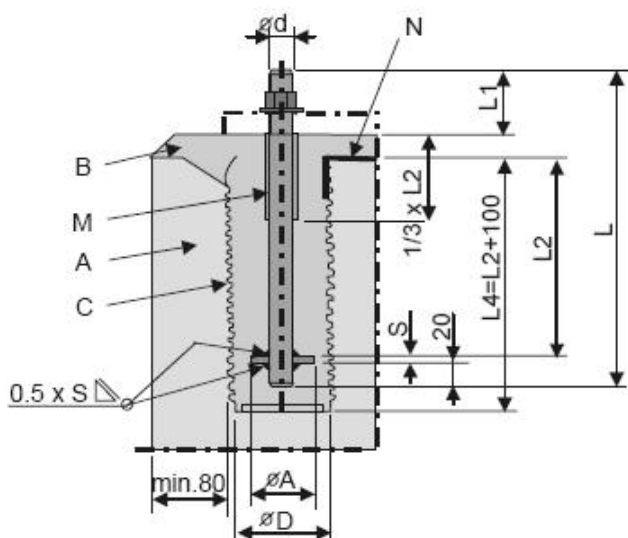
Короткие фундаментные болты с фланцем: размеры фундаментного болта стандарта SFS 4632, тип A. На рисунке обозначены: бетонный фундамент (A), вторичное бетонное покрытие (B1), фундаментное гнездо (C), крепежная скоба (N) и антиадгезивное покрытие (M).
